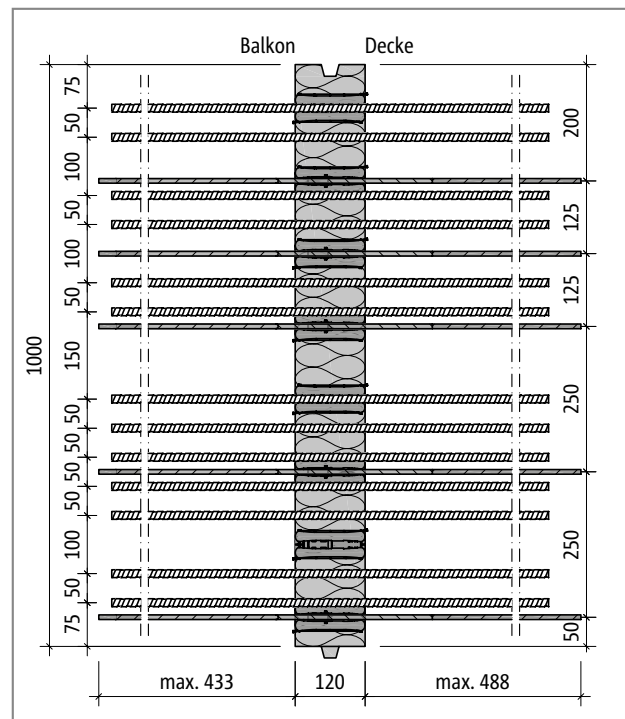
Schöck Isokorb® Typ KXT50-Combar-V8: Produktgrundriss
